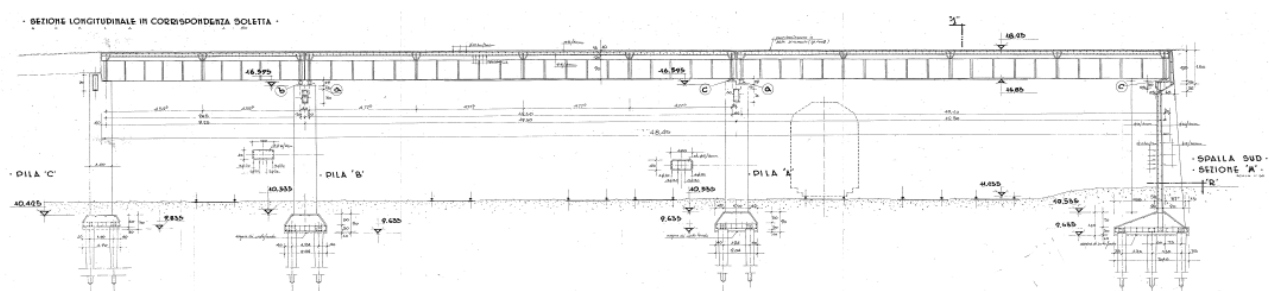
Estratto della tavola 1658/1b redatta dalla ditta SALC nel 1959 – Prospetto laterale
